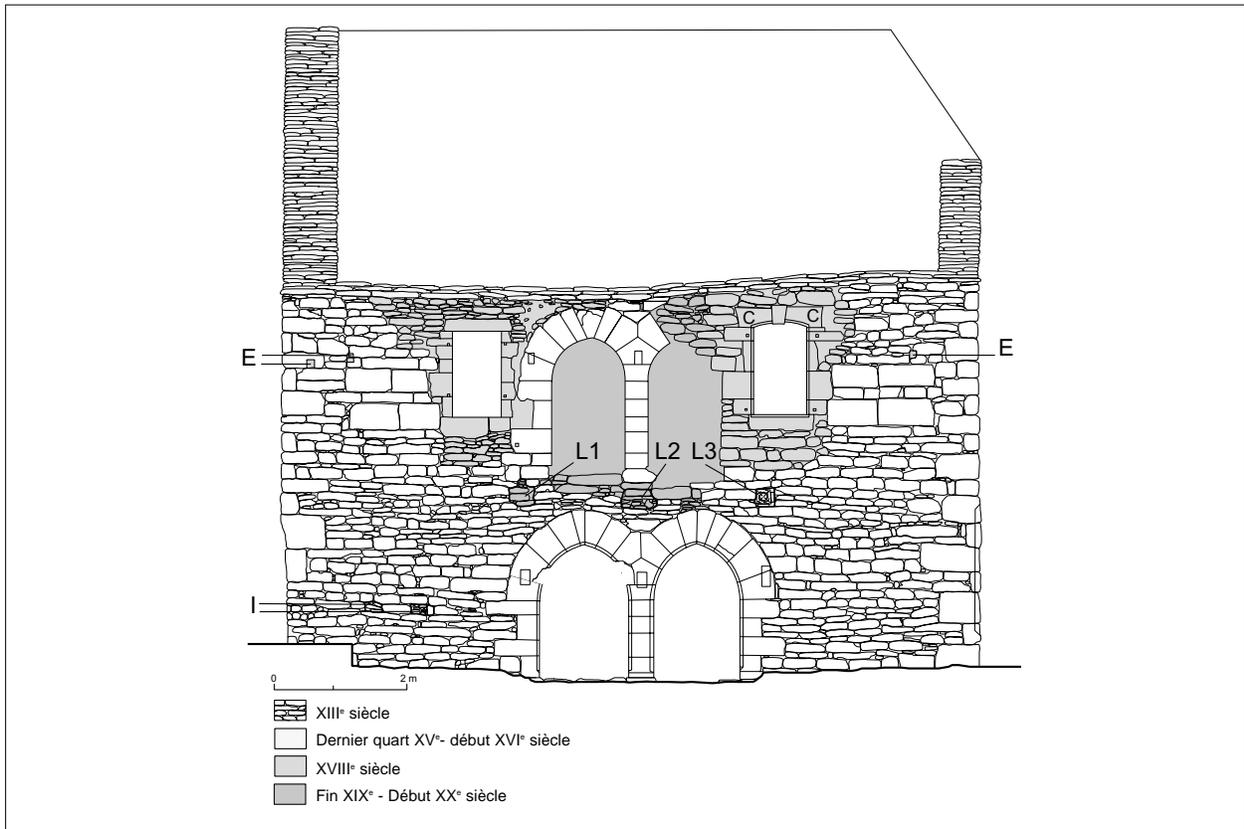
MAISONS JUMELLES N° 1. Façade principale orientée à l'ouest. Relevé V. Rousset, 2001.
